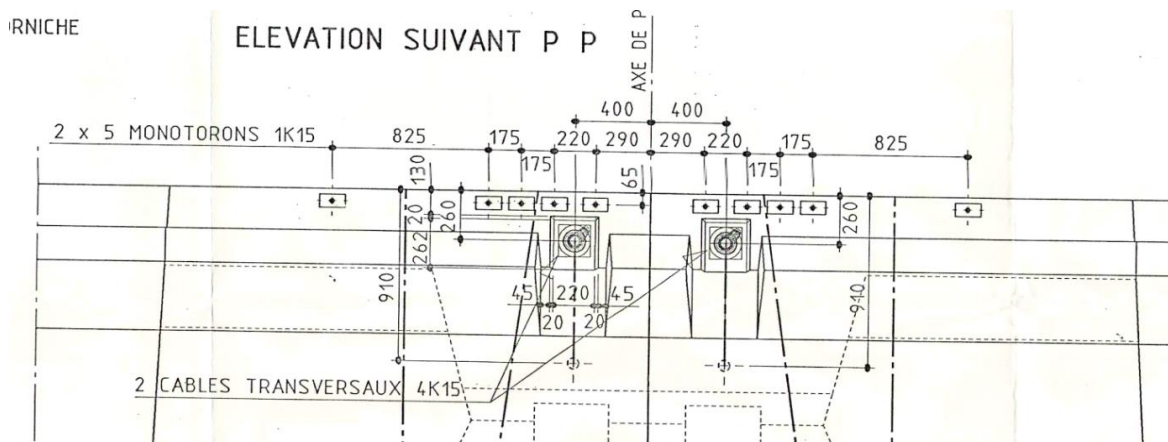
Précontrainte transversale sur pile : vue latérale (extrait plan P432)
